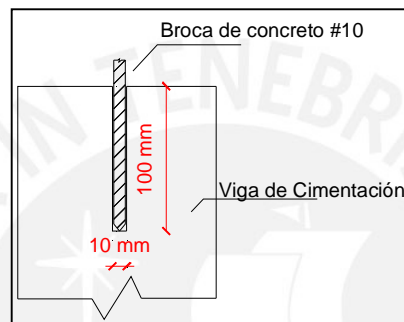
Corte transversal del anillo de cimentación para anclaje de refuerzo del murete M3.
